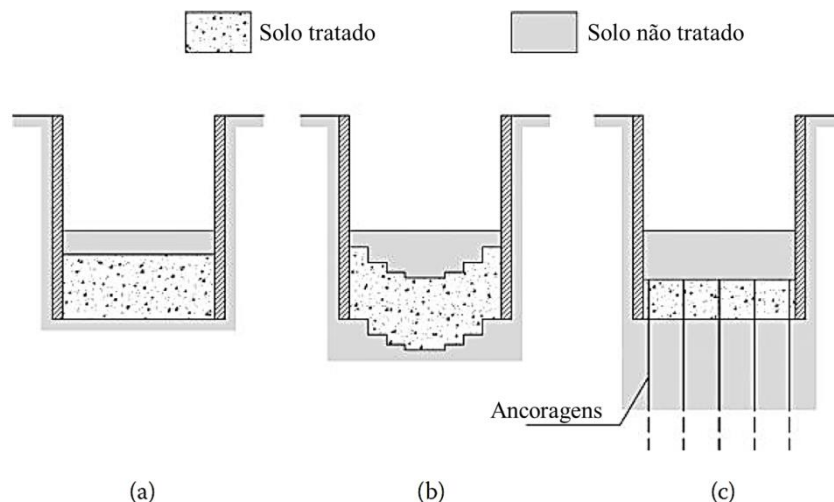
Três esquemas de rolhão de fundo de *jet-grouting*: (a) laje retangular; (b) arco invertido; (c) laje ancorada (Croce *et al.*, 2014)
